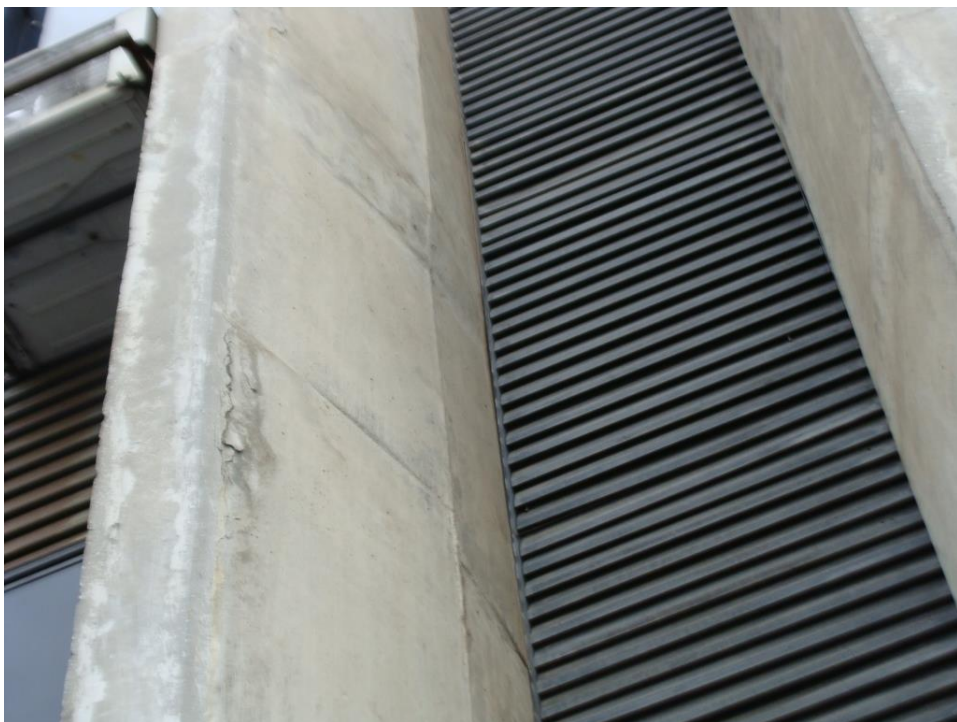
Armadura exposta pilar P13 (3º pavimento) (02/03/2021)
